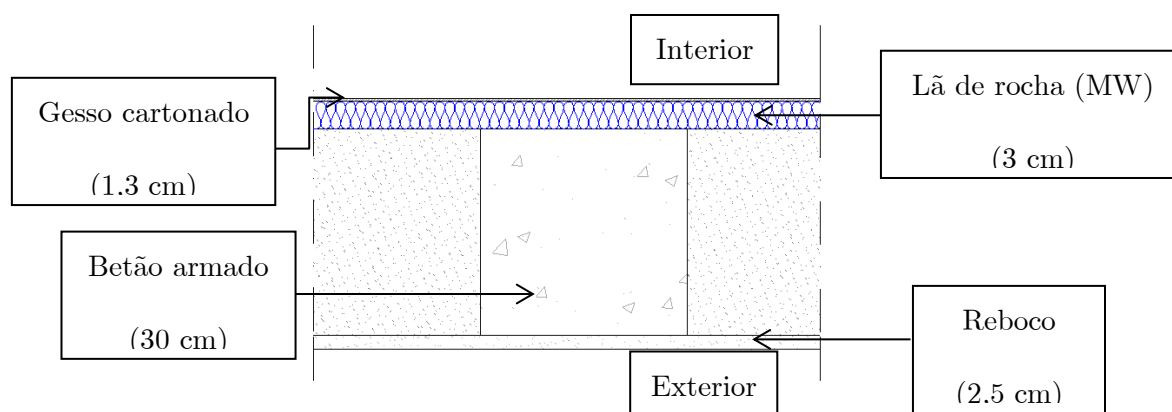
Pormenor construtivo dos pilares (N<sub>1</sub>)
